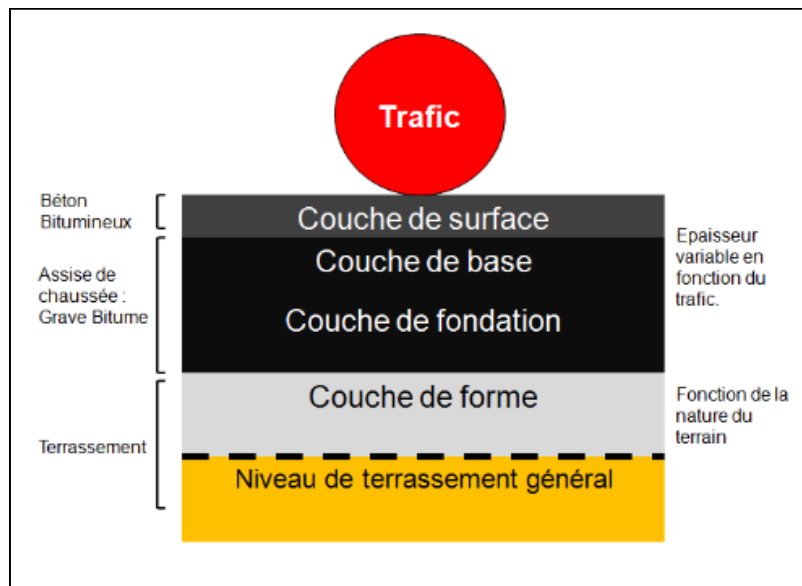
Structure d'une chaussée bitumineuse épaisse.
